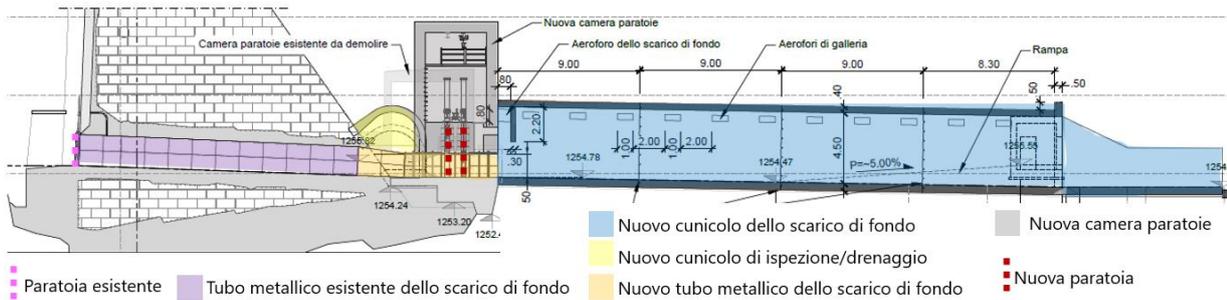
nuovo cunicolo di accesso e scarico di fondo, sezione longitudinale
